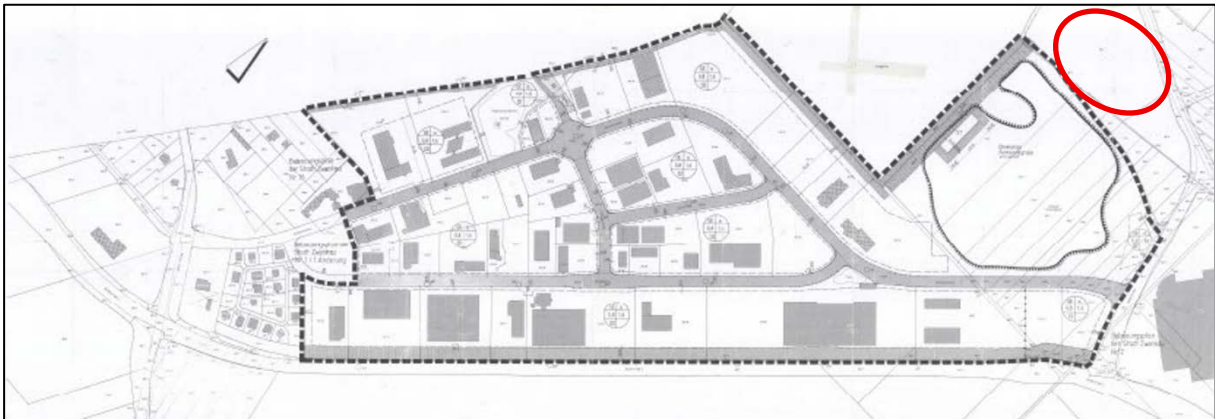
Auszug aus dem B-Plan Nr. 1 der Stadt Zwenkau, 2. Änderung
